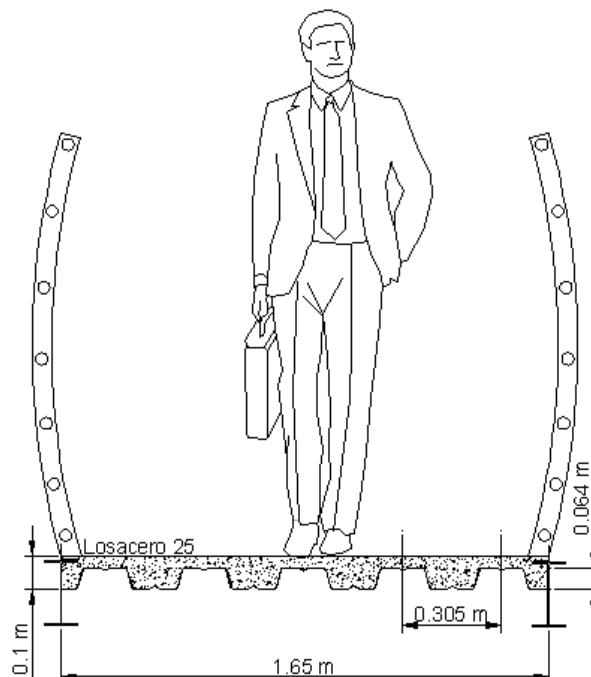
Detalle de la sección transversal de la calzada peatonal del puente peatonal Salamanca
